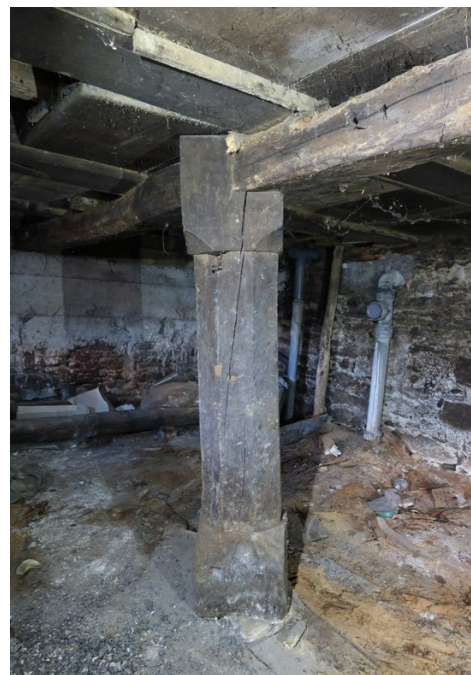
Buschwiller, 16 rue de Wentzwiller.
